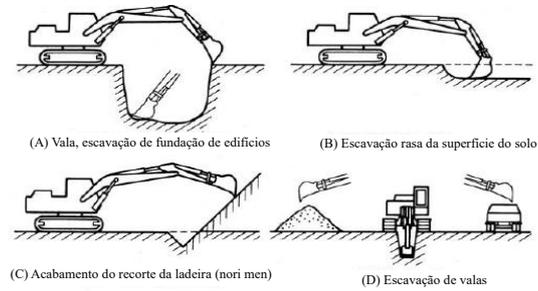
Exemplo de trabalho básico com uma escavadeira hidráulica (retroescavadeira)
